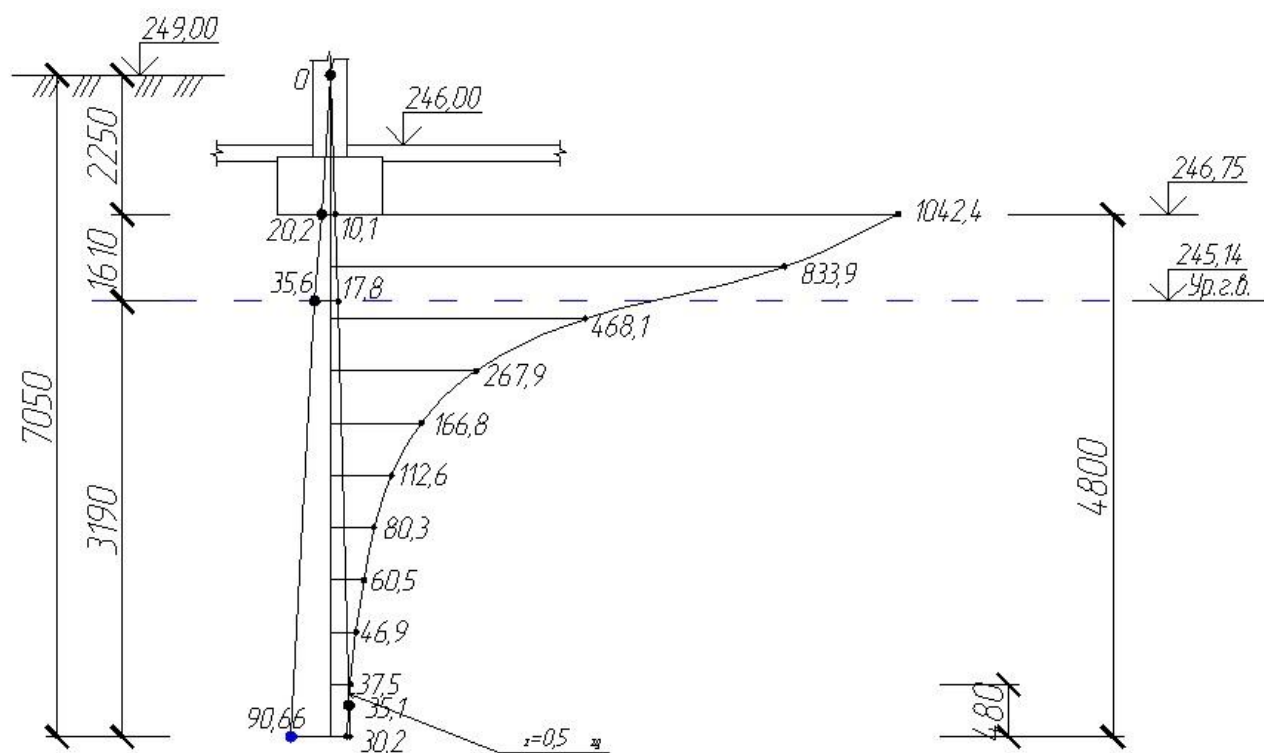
Эпюра напряжений фундамента под средней колонной
